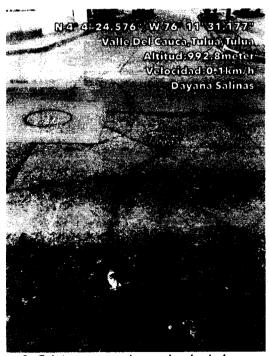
Grietas generadas en la vía de la carrera 41
